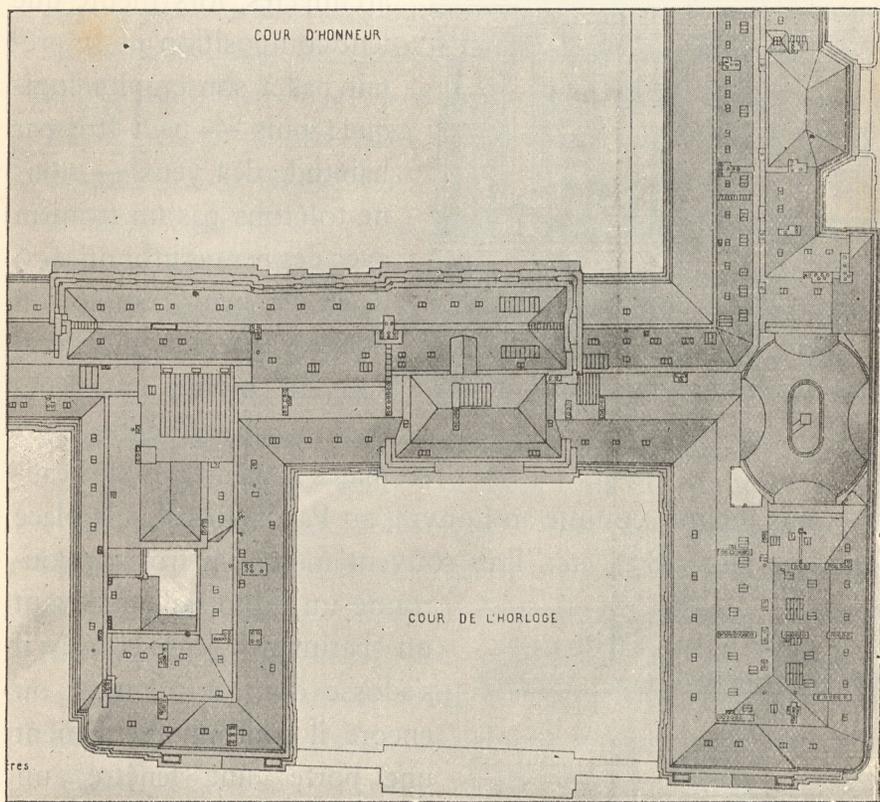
Plan d'une partie des toitures du Palais-Royal.
